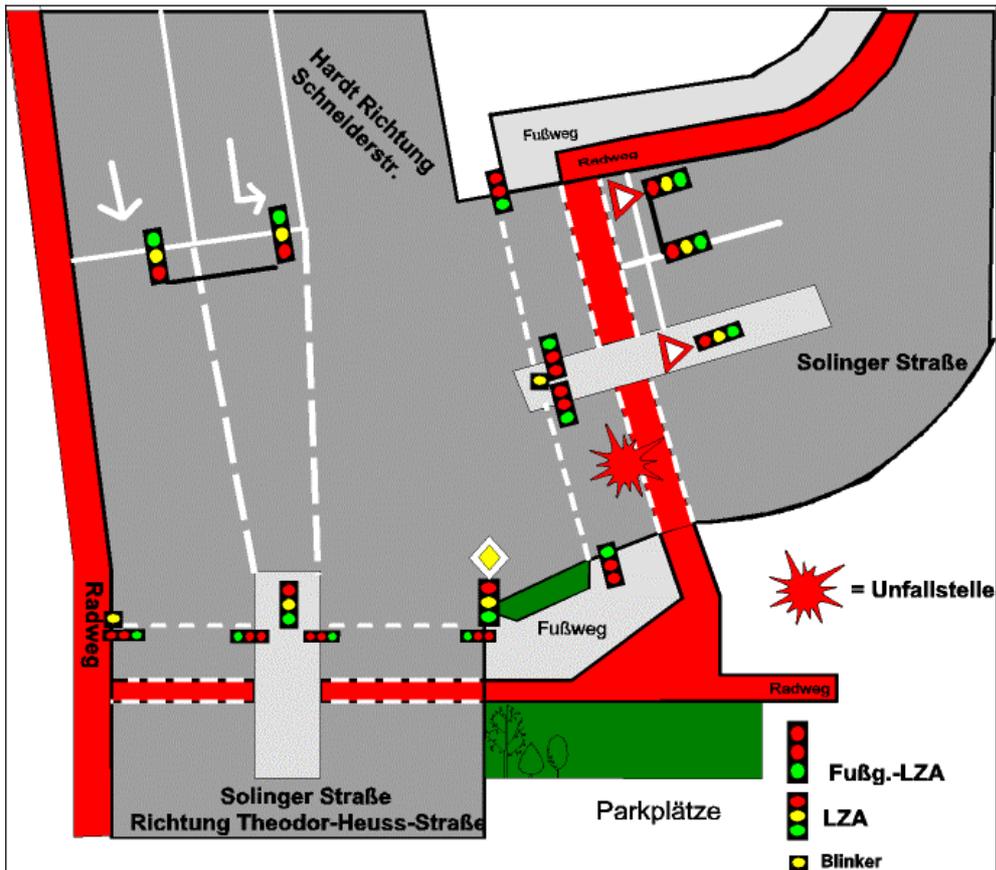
Detailskizze Unfallstelle Ecke Solinger Str./Solinger Str./Hardt
